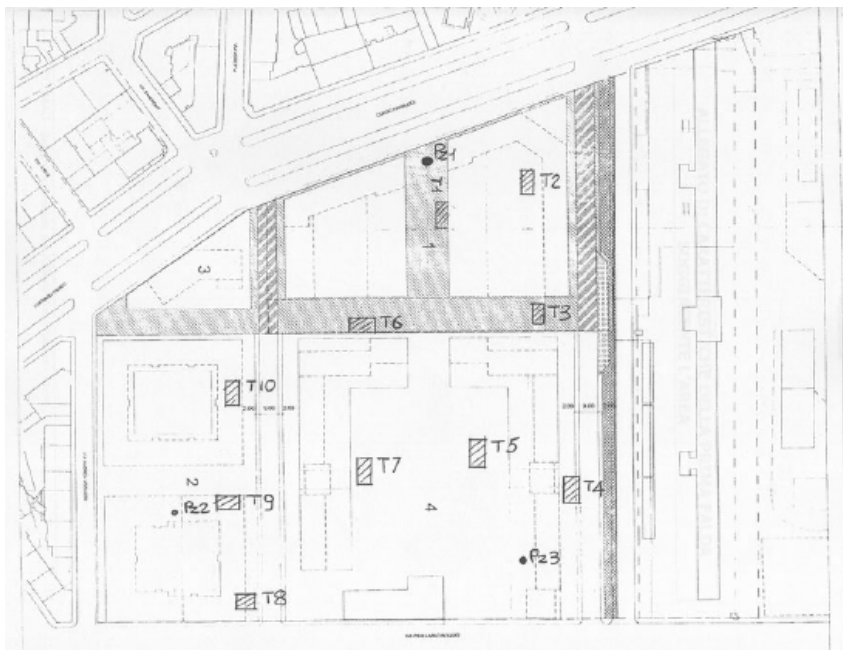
Planimetria dell'area e localizzazione delle trincee
